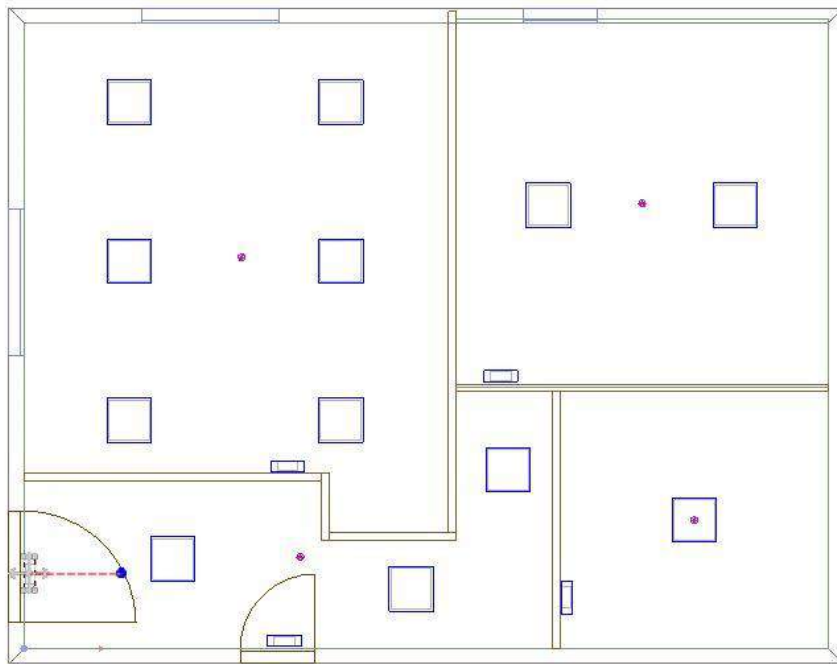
Ubicación de las luminarias en la planta Alta.
